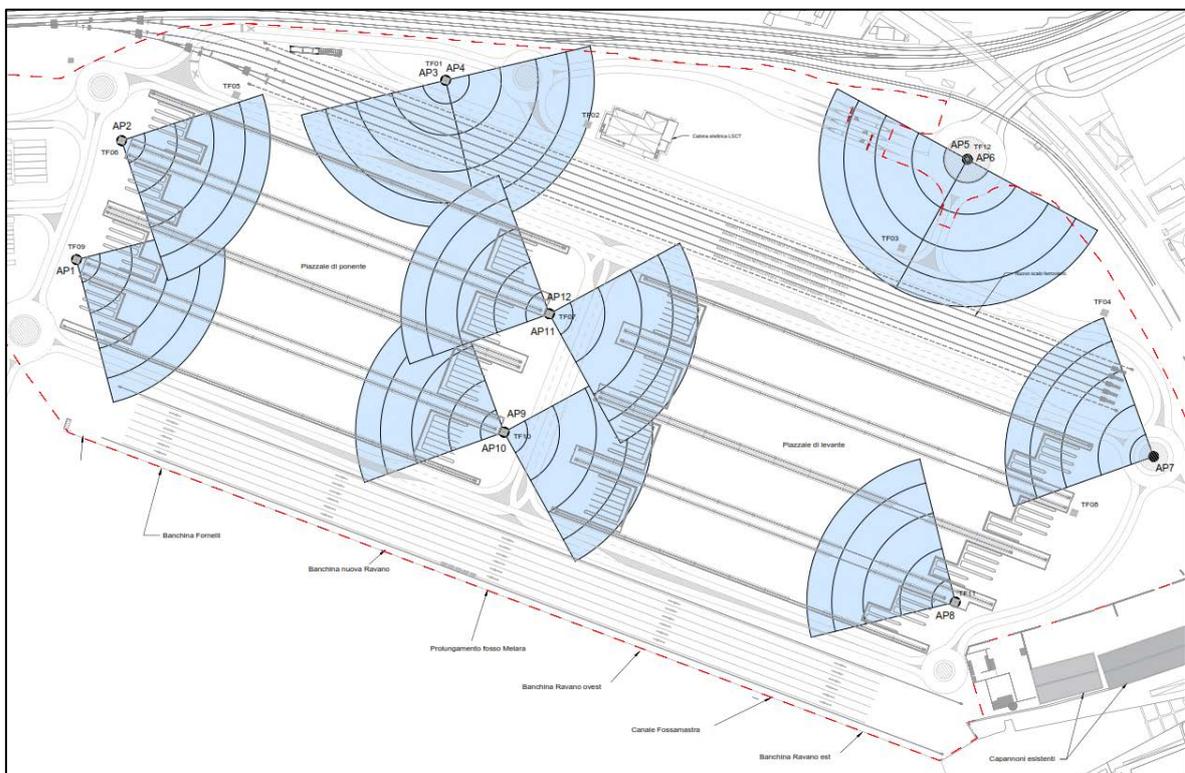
Sistema WiFi – Planimetrico (21\_08\_PE\_TV09)
